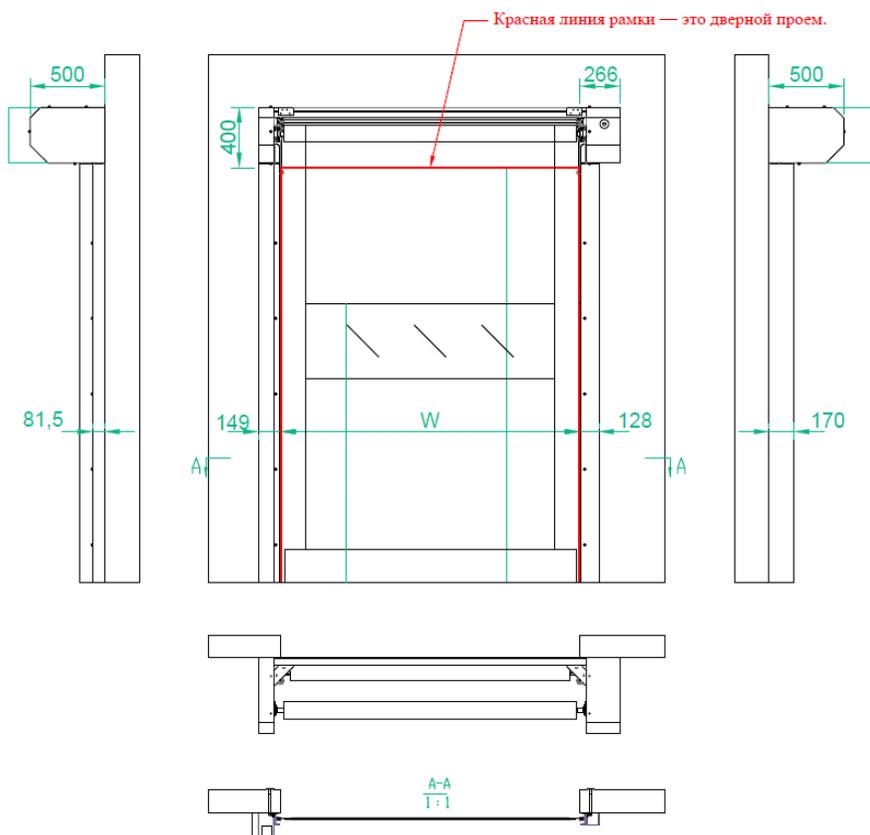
DZ/P-DZ/F-DZ установочные размеры
